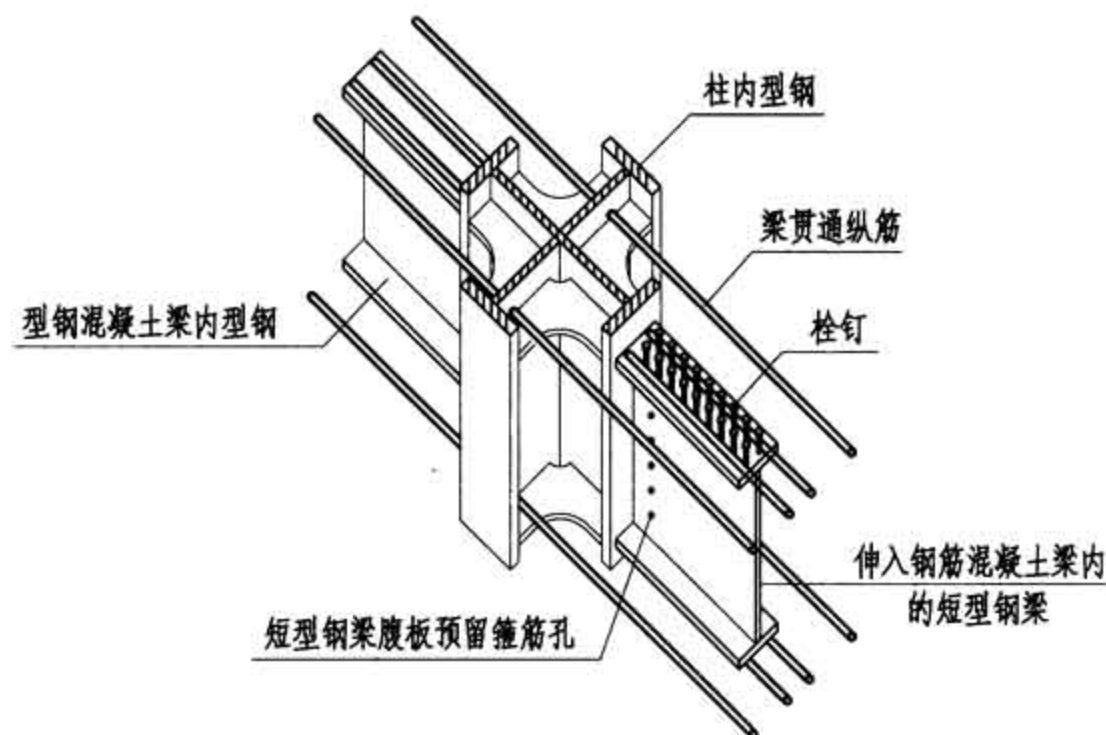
框架节点两侧分别为型钢混凝土梁和钢筋混凝土梁
